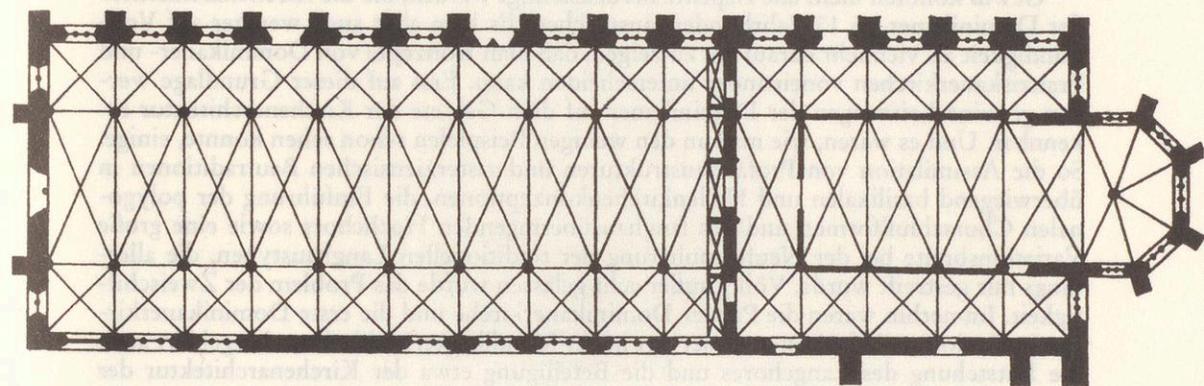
Erfurt, Predigerkirche, Grundriß (nach Krautheimer 1925)
